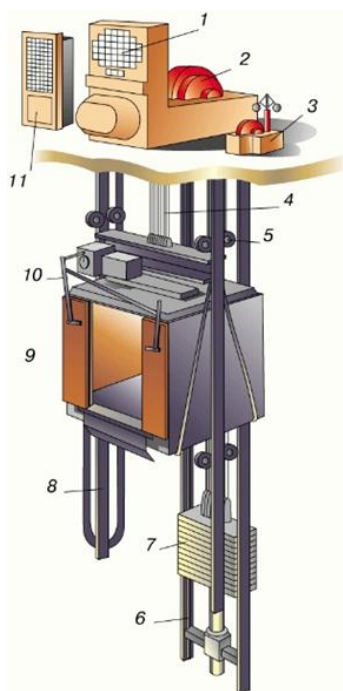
Конструкция лифта с электромеханическим приводом: 1 — электродвигатель; 2 — лебедка; 3 — ограничитель скорости; 4 — тяговые канаты; 5 — направляющие ролики кабины; 6 — направляющие противовеса; 7 — противовес; 8 — направляющие кабины; 9 — кабина; 10 — дверной механизм; 11 — пульт управления
